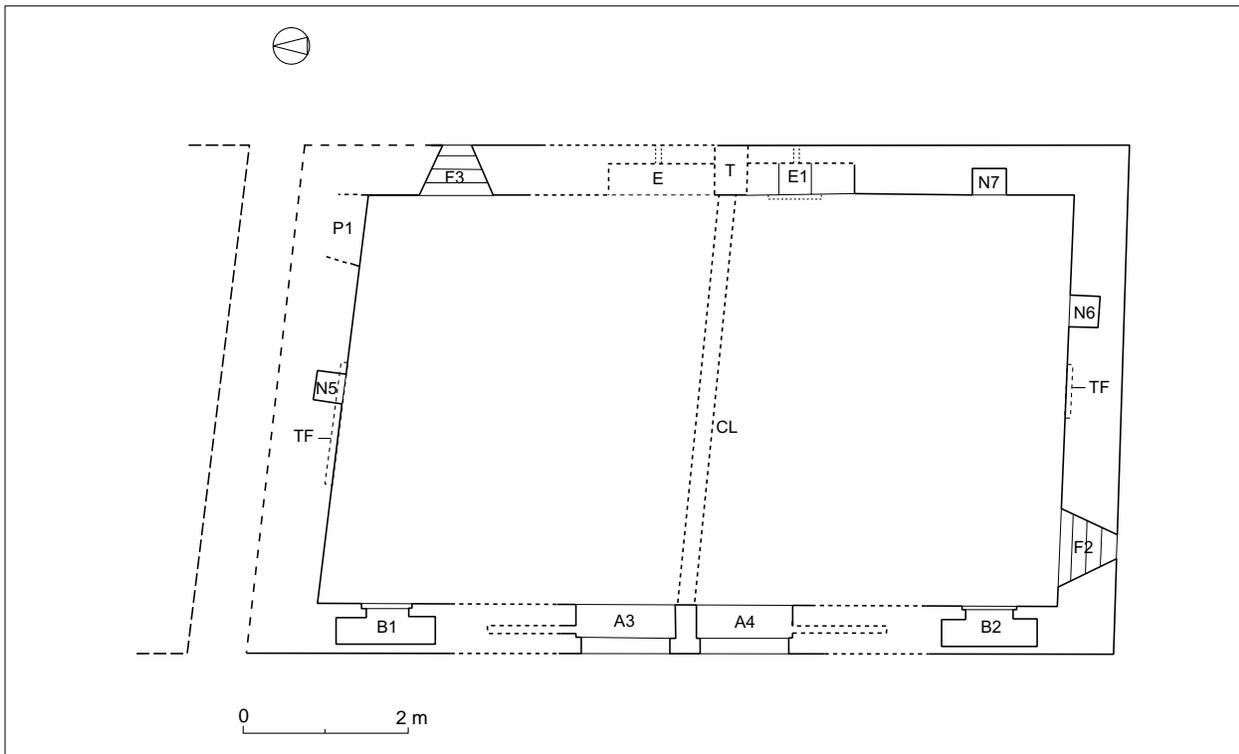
MAISONS JUMELLES N° 1. Plan de l'étage : proposition de restitution des dispositions du XIII<sup>e</sup> siècle. Dessin V. Rousset, 2001.
